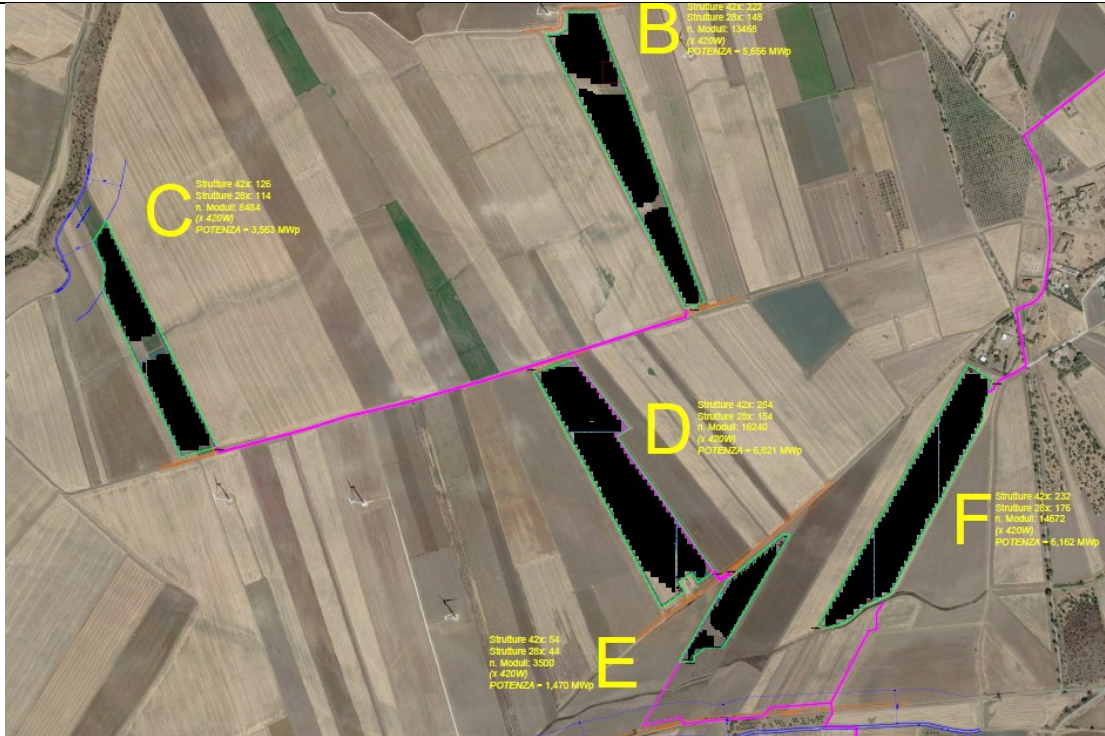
Layout di impianto dell’Area B-C-D-E e F
